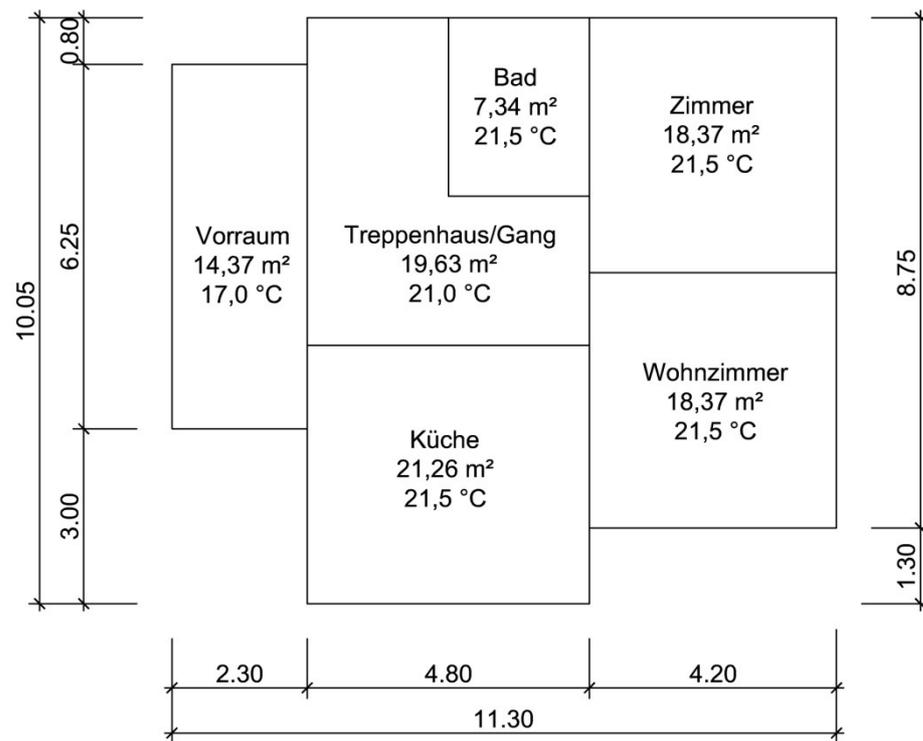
Grundriss: konditioniertes Erdgeschoss
